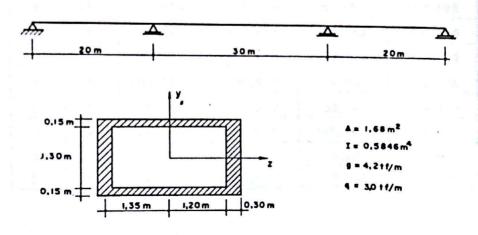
ESQUEMA DA VIGA E CARACTERÍSTICAS DA SEÇÃO
